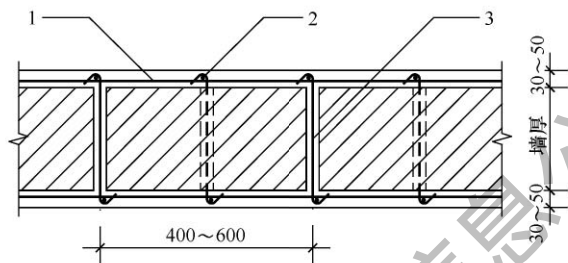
外加双面配筋砂浆带圈梁剖面图
